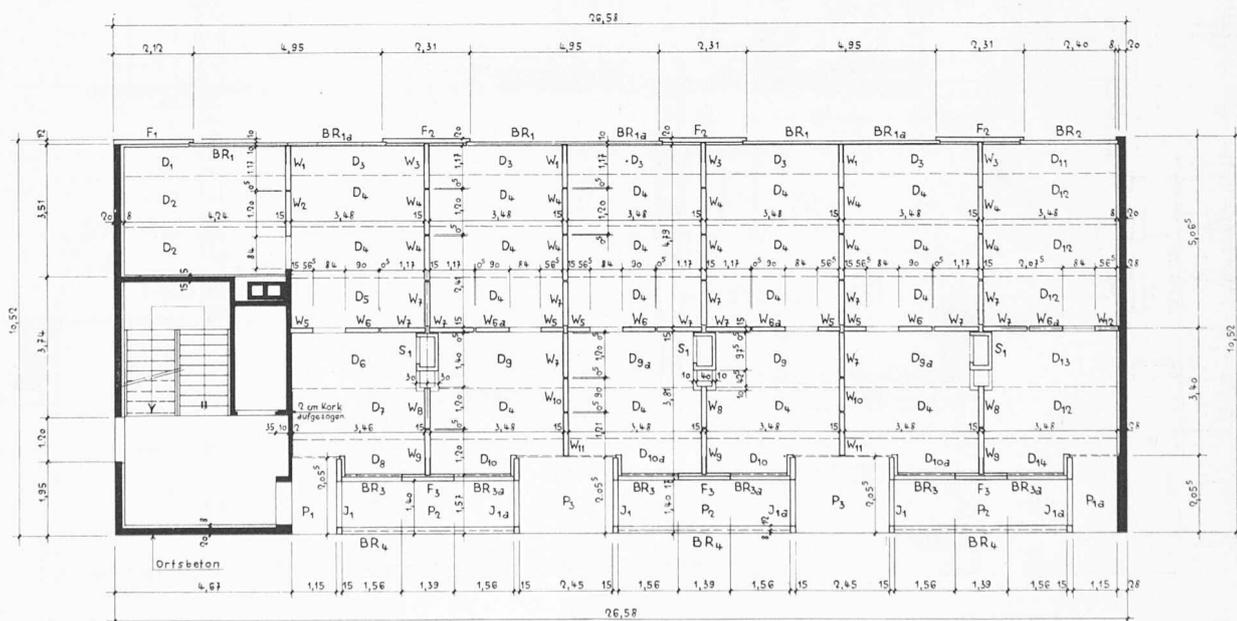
Normalgeschossgrundriss 1:200 des Hochhauses. Montageplan für die Verlegung der Elemente. Treppenhaus und Nordwestseite in Ortsbeton
